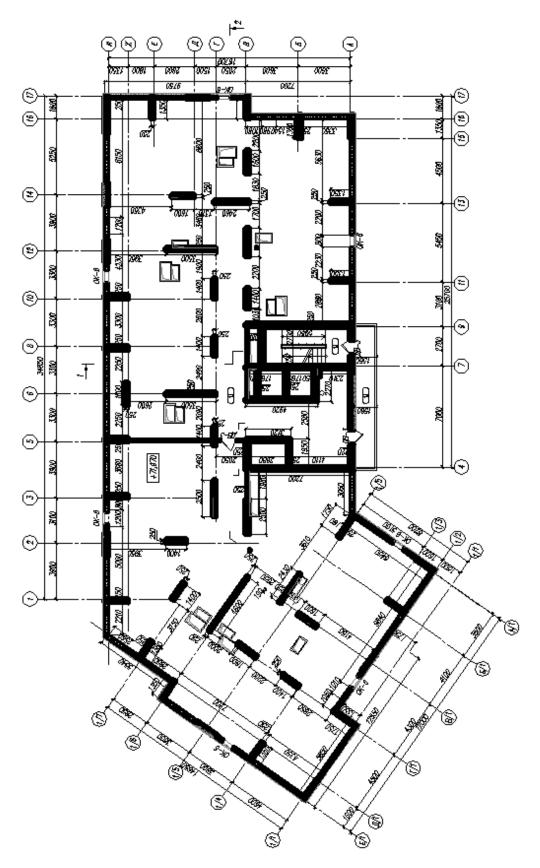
План технического этажа на отметке плюс 71,970
